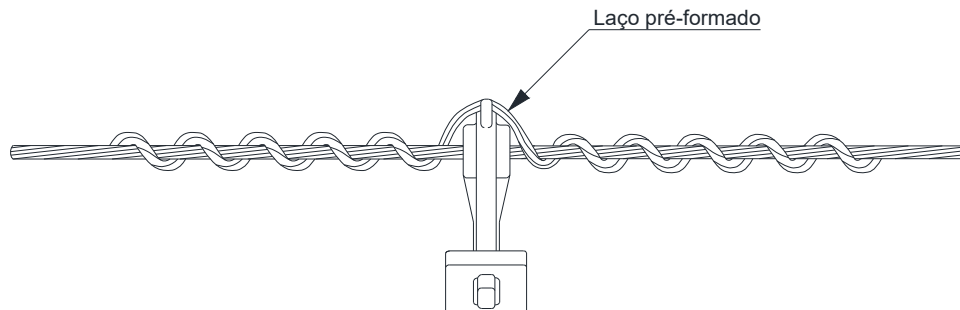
Amarrações e ligações – Amarração do espaçador monofásico, vertical e losangular em cordoalha – Laço pré-formado
